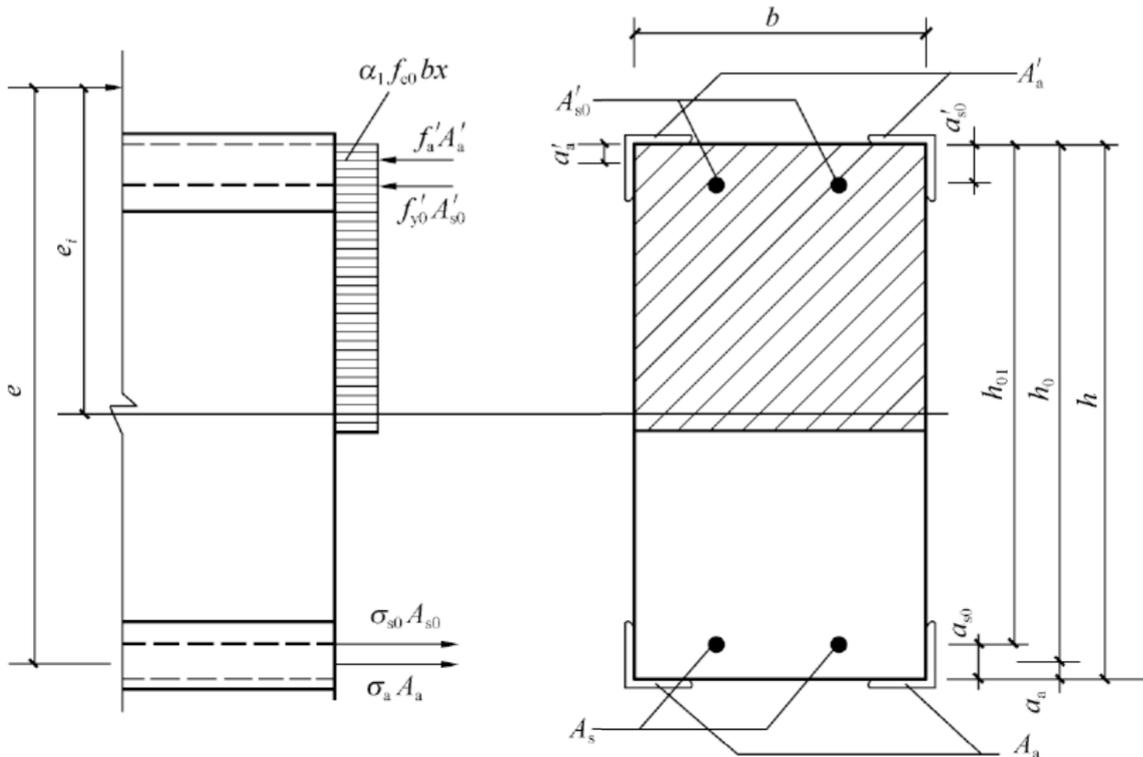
外粘型钢加固偏心受压柱的截面计算简图
